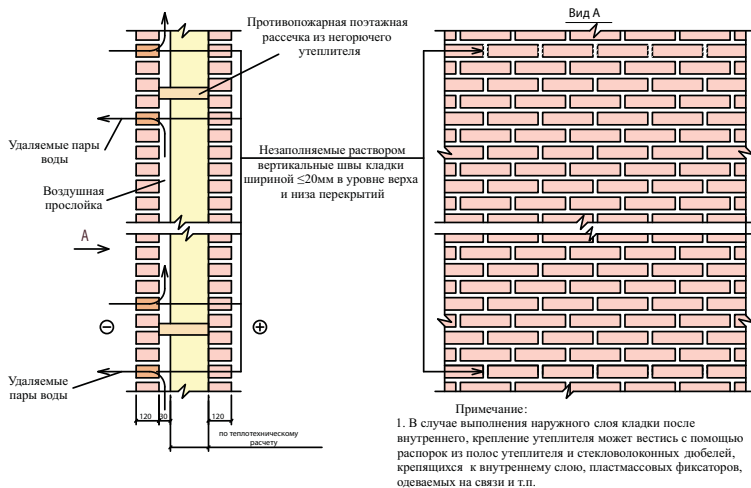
Схема устройства вентилируемой воздушной прослойки
